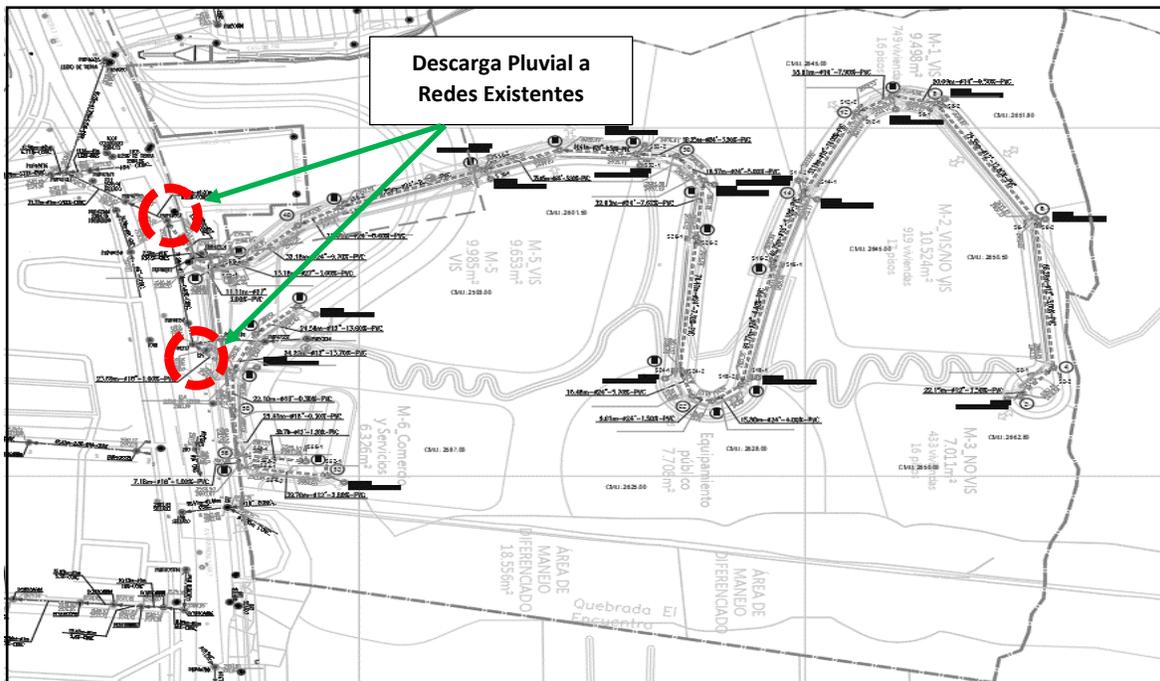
Esquema de Redes Locales Plan Parcial Delta Silical Calicanto.
